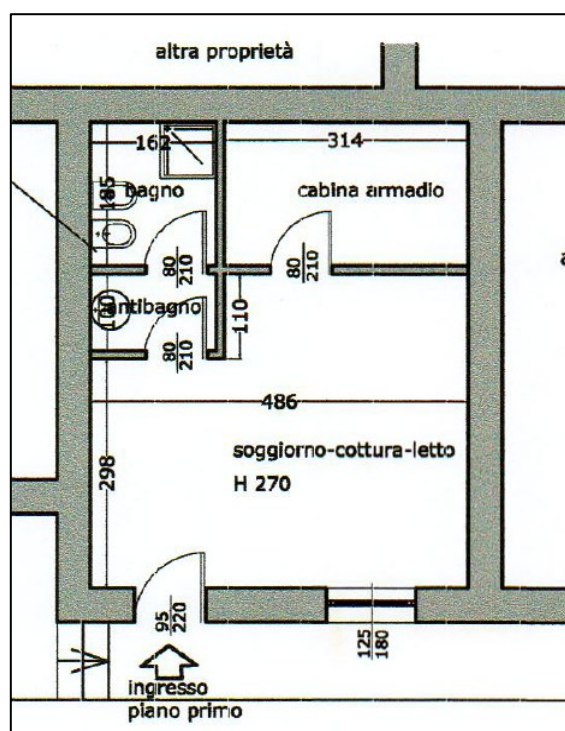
Planimetria allegata a DIA del 5.02.2007
